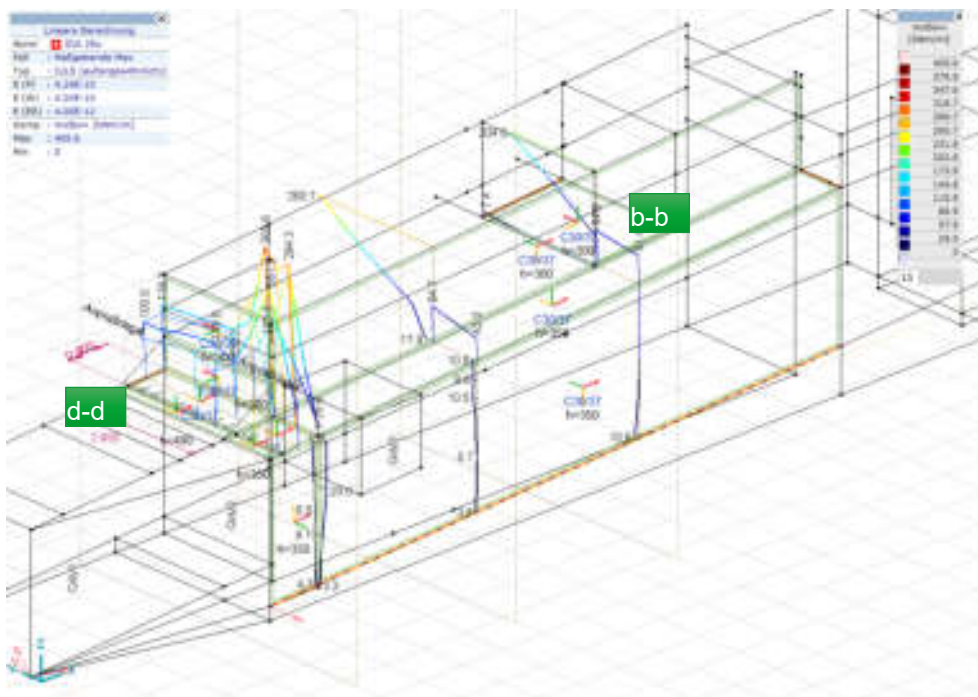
Schnitt: Brüstung horizontal innen; Decke / Wand Längs (Verteilarmierung)
